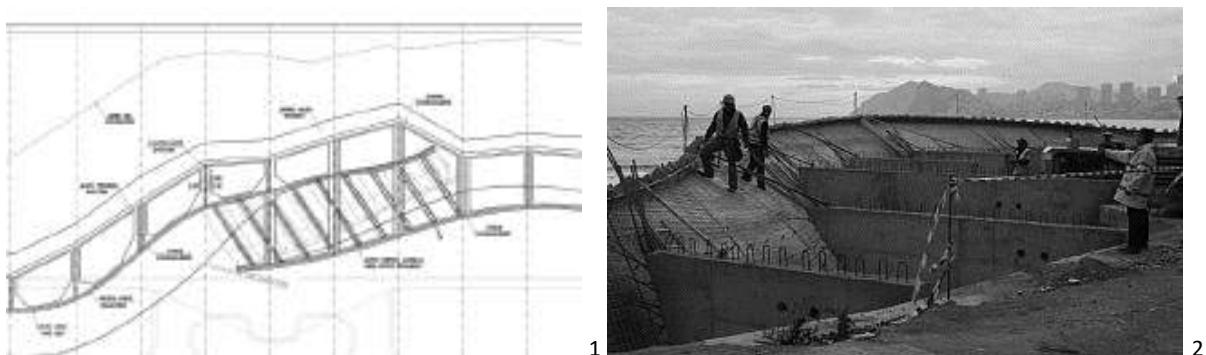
1. Plano de un sector con disposición regular y paralela de muros de contención. 2. Fotografía del paseo en la fase de construcción.
